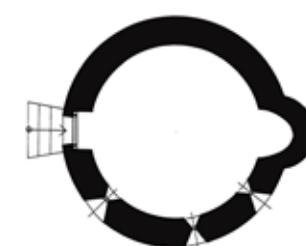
Grundriss Glantschach, M 1:200. TU Graz. 1981.
